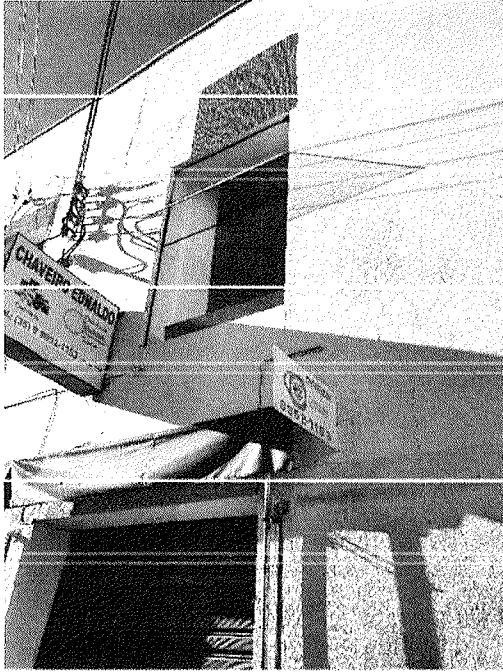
Fissuras e trincas em diversas áreas externas da edificação
